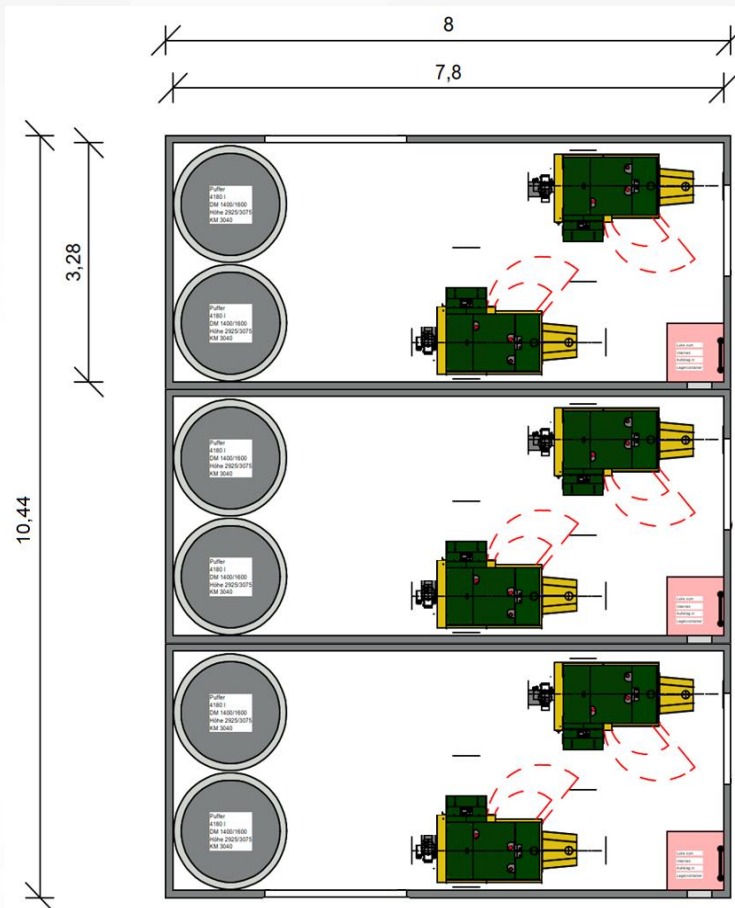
Möglicher Grundriss Erdgeschoss der reinen Pellet Variante. Abgasführung und Kesselposition müssten abgestimmt werden (Hersteller, 06/2023, Eigene Bearbeitung)
